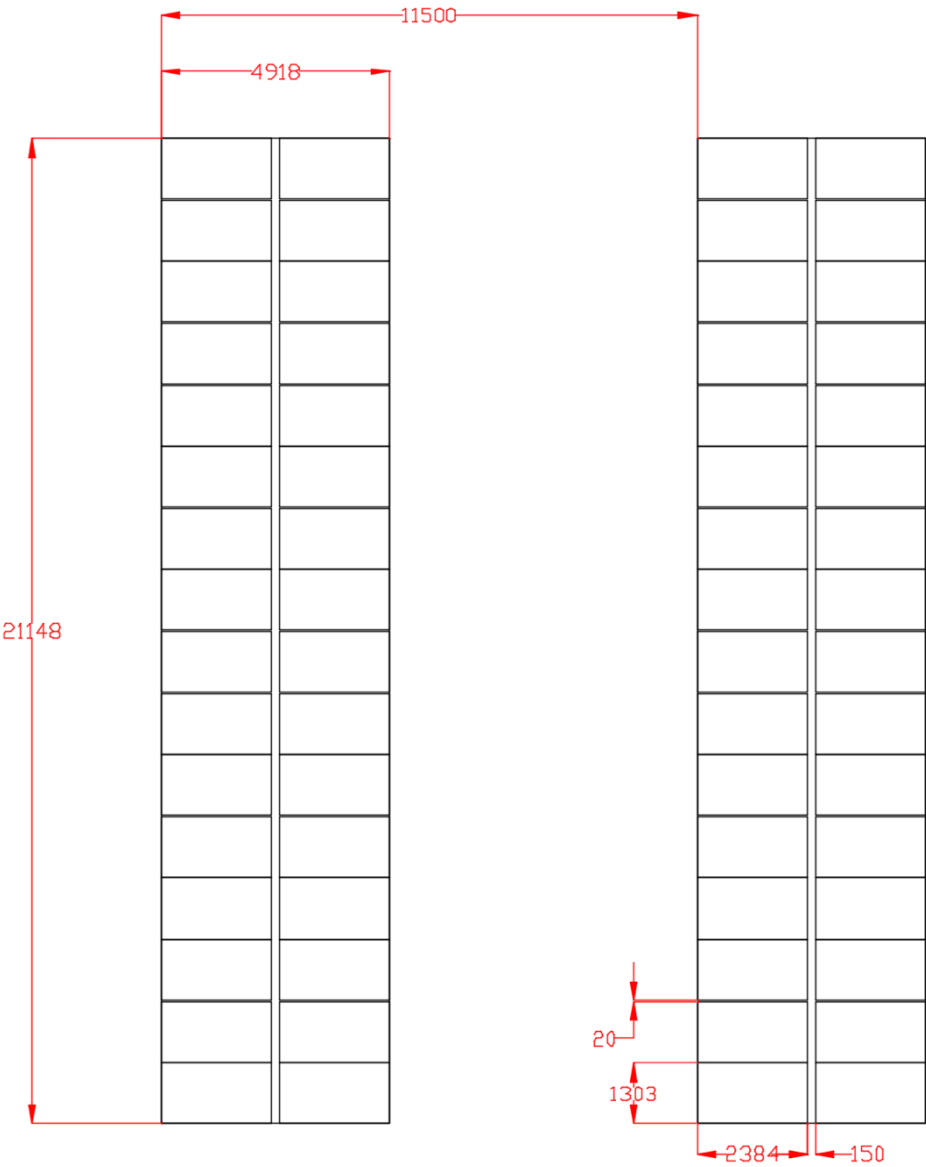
Vista in pianta delle stringhe fotovoltaiche previste a progetto
